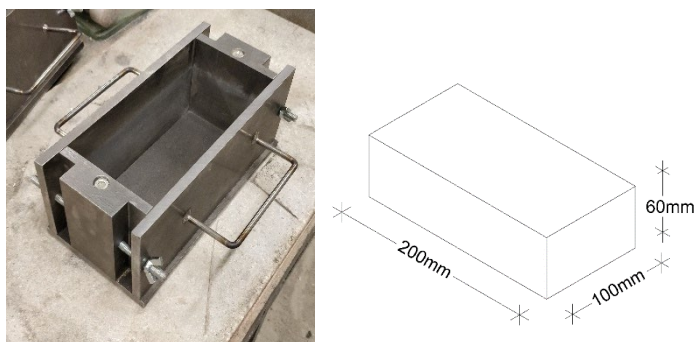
Molde empleado (izq.); Dimensiones adoquín
